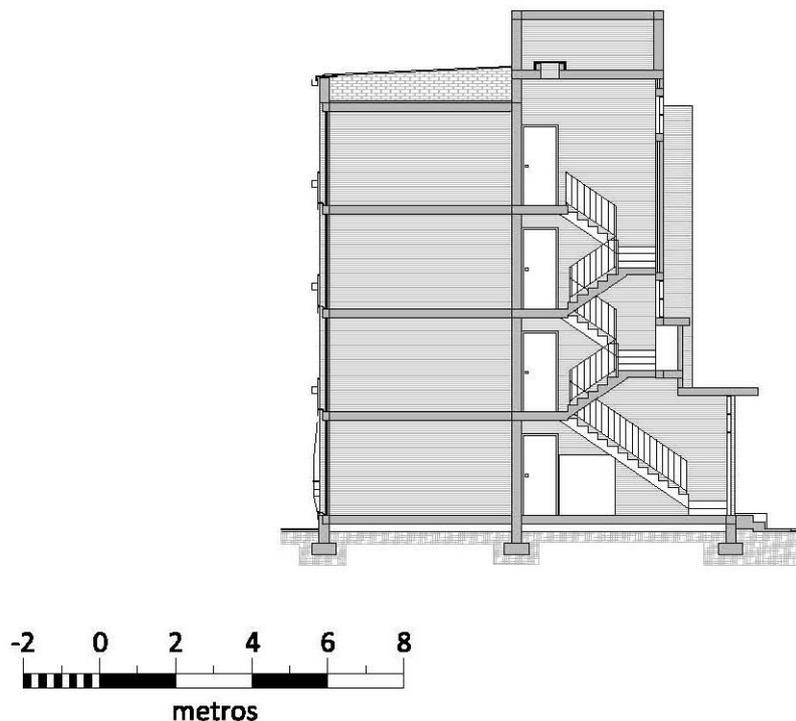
Plano de sección transversal, escalera 1 ó 2. Escala 1:200
